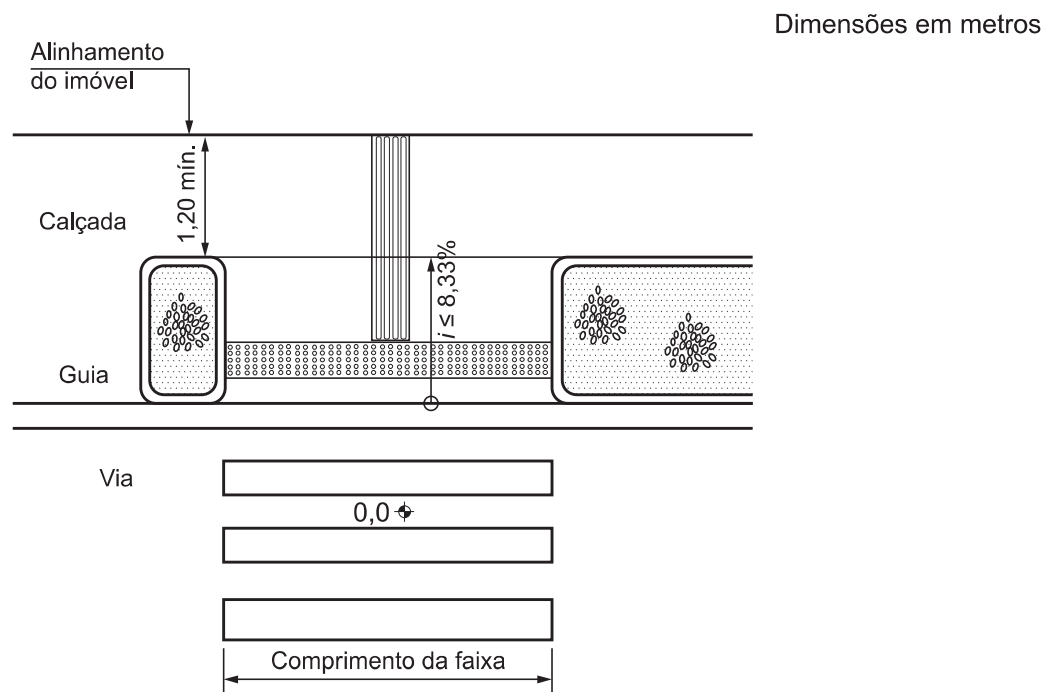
Rebaixamentos de calçada entre canteiros – Vista superior
